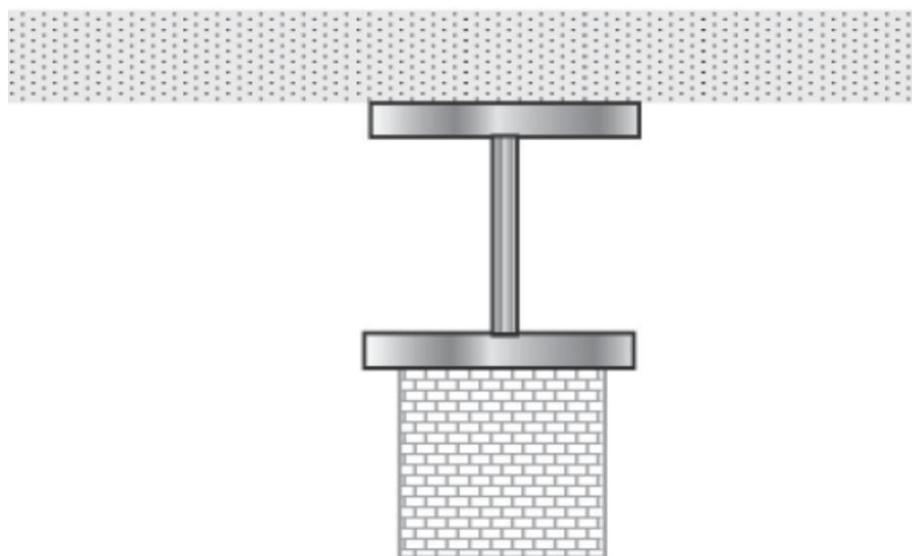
Viga de aço com laje de concreto e sobre alvenaria (corte).
